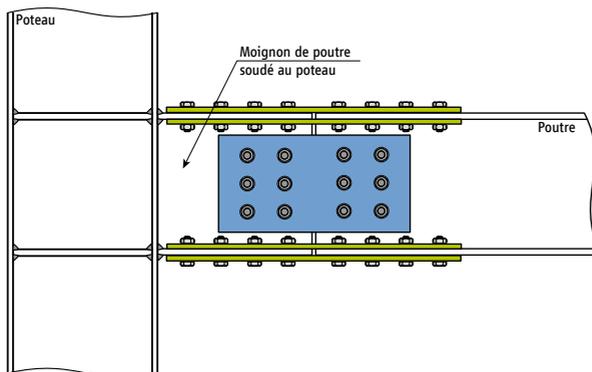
Assemblage de continuité d'une poutre sur un poteau par éclissage
